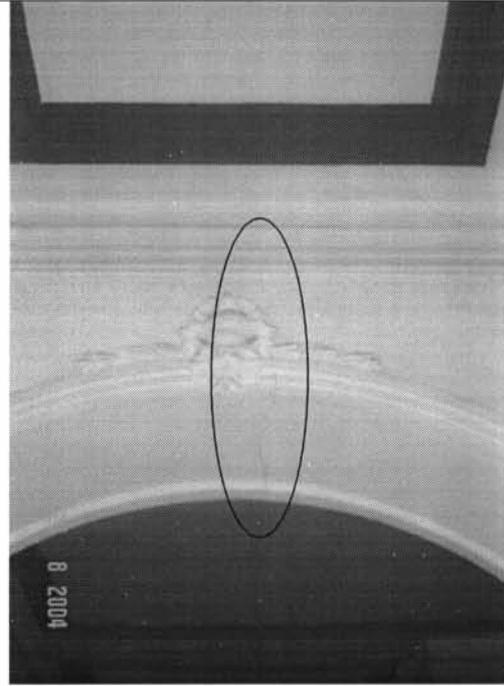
Detalle de grieta en el arco del Hall principal en el piso superior.
